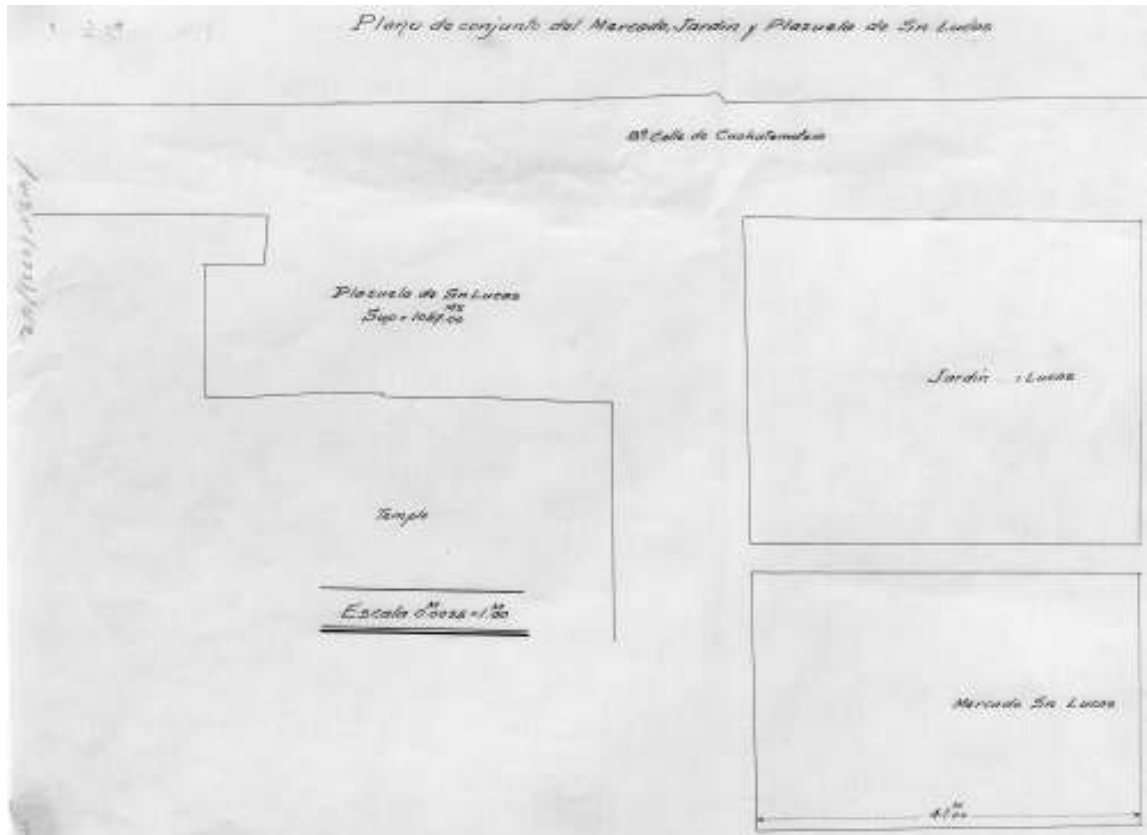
Plano de conjunto del Mercado y Plazuela de San Lucas. AHDF, Planoteca. Módulo 1, planero 4, fajilla 5, clasificación: 413(073)42. Fotografía de Javier Otaola.
